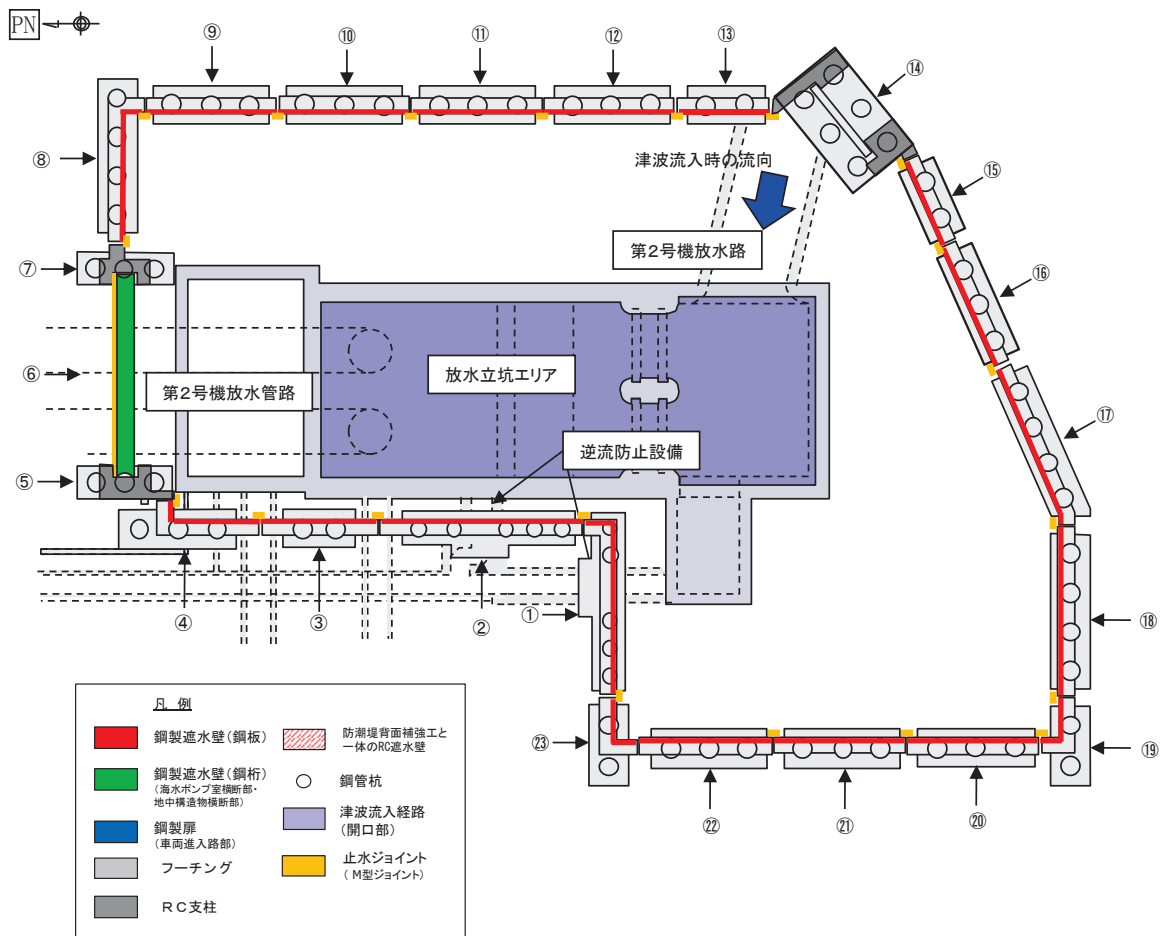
(1) ボイリング評価検討箇所平面図 (防潮壁 (第 2 号機放水立坑))
